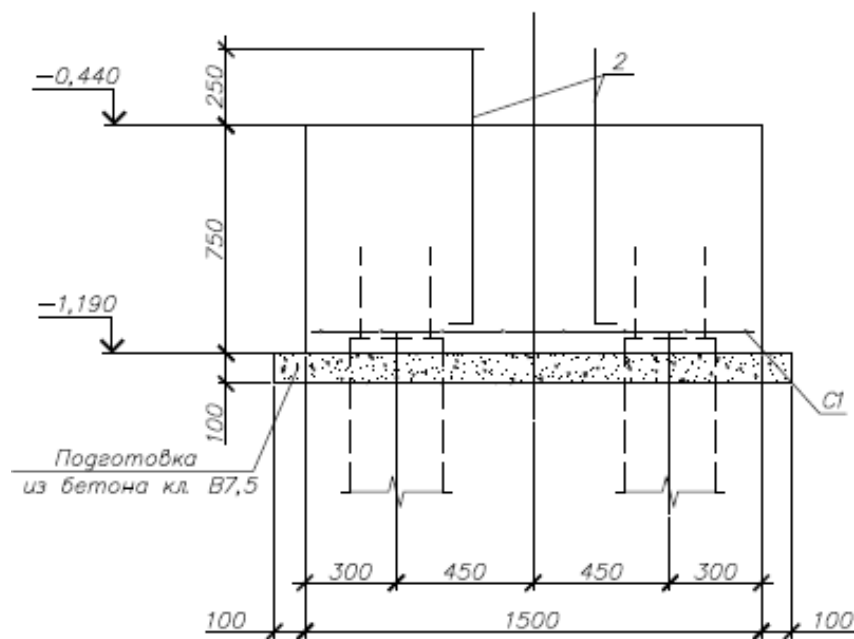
Опалубочный чертеж ростверка
